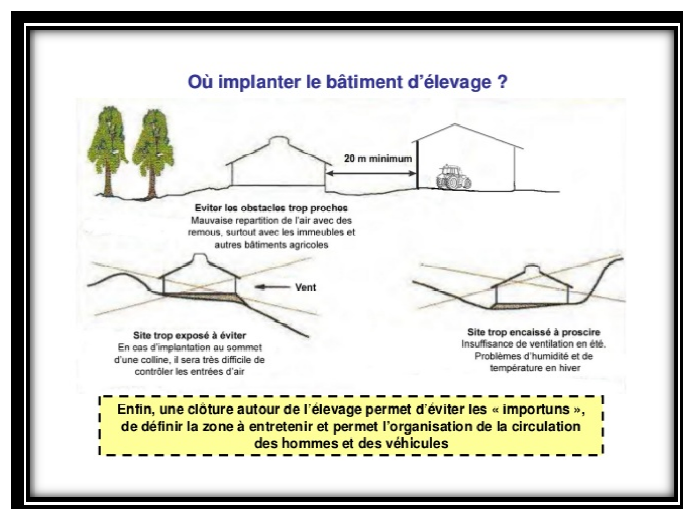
Implantation du bâtiment d'élevage. (Lebas, 2009)
